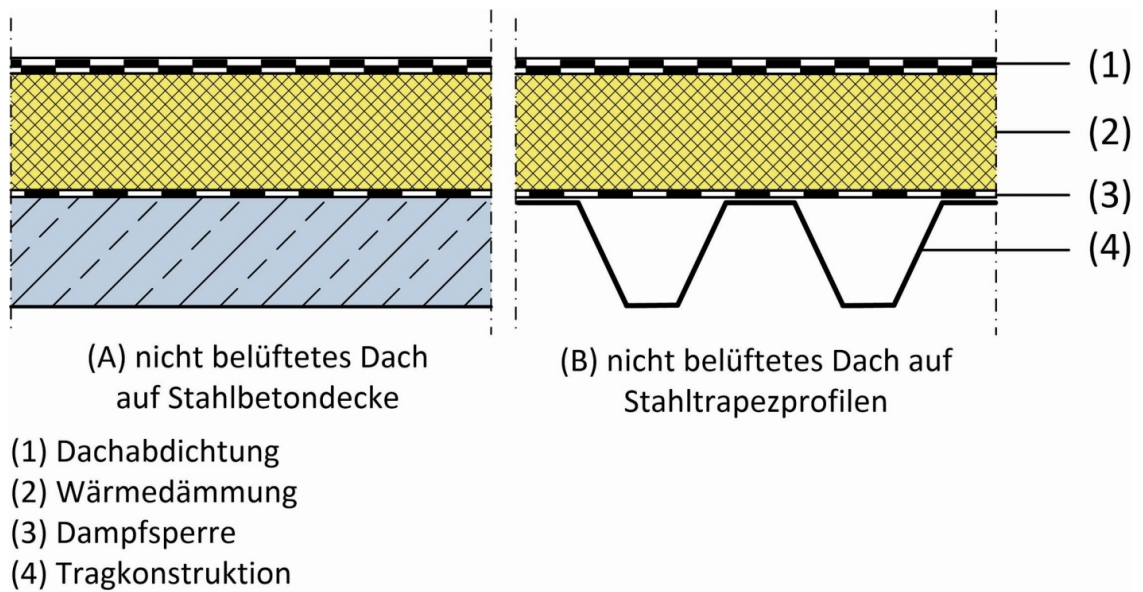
Beispielquerschnitte: (A) nicht belüftetes Dach auf einer Stahlbetondecke; (B) nicht belüftetes Dach auf einer Unterkonstruktion aus Stahltrapezprofilen (Quelle: Schmidt)
